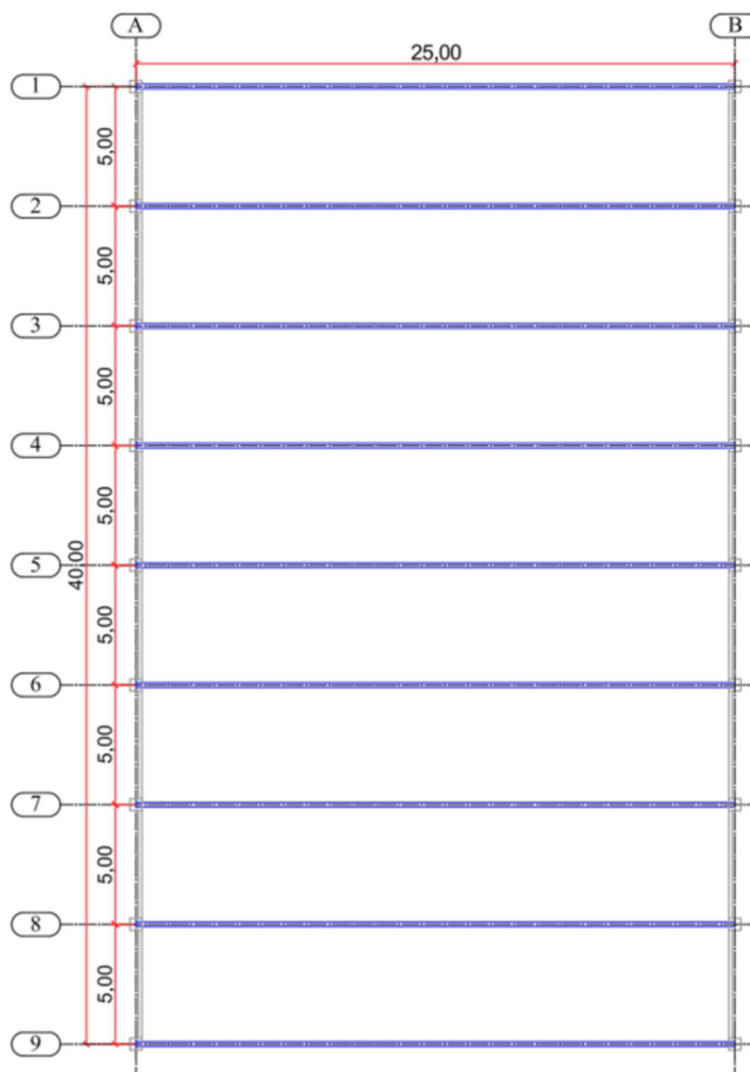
Vista em planta da Cobertura (unidades em "m")
